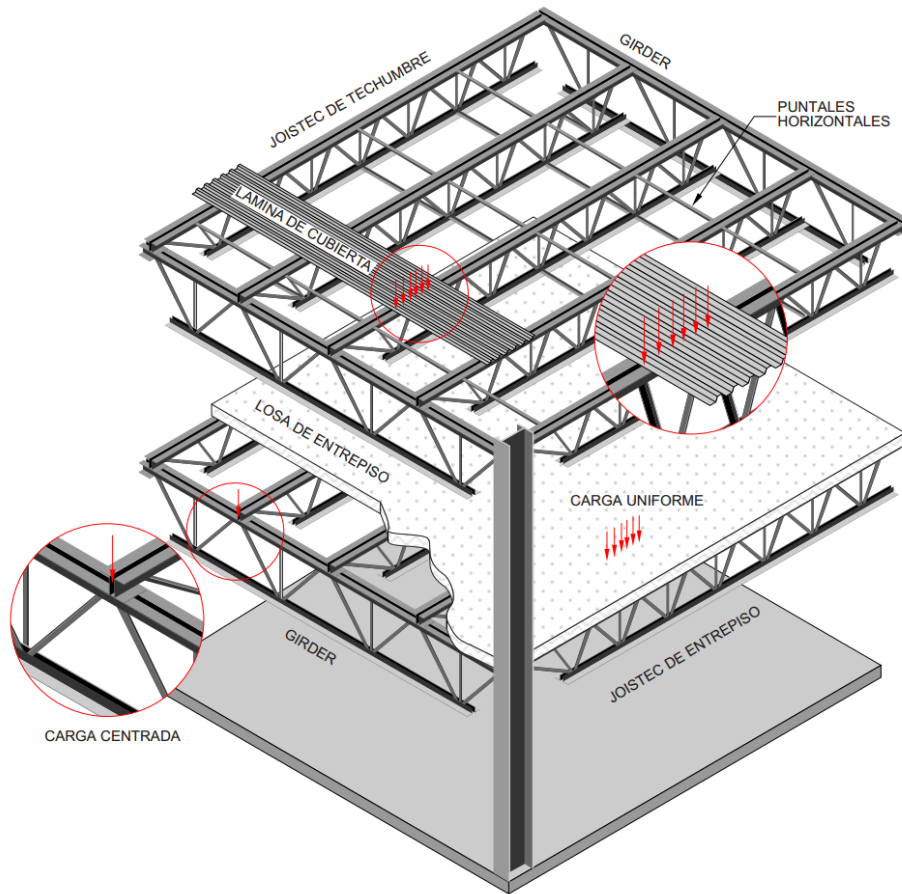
Construcción sistema Joistec. (Archdaily, 2014)
